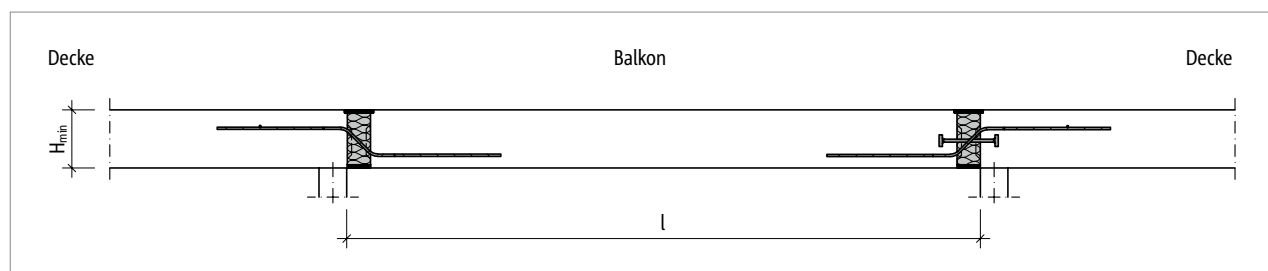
Schöck Isokorb® T Typ QP-Z, QP: Statisches System
